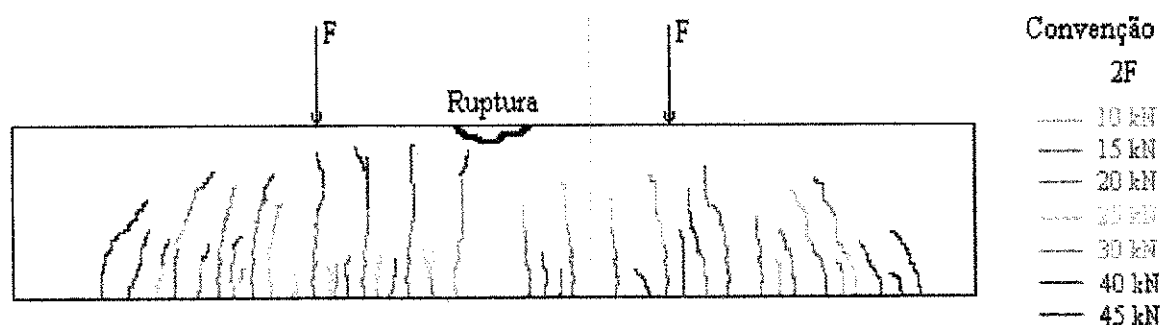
Evolução das Fissuras para a Viga VL-02
